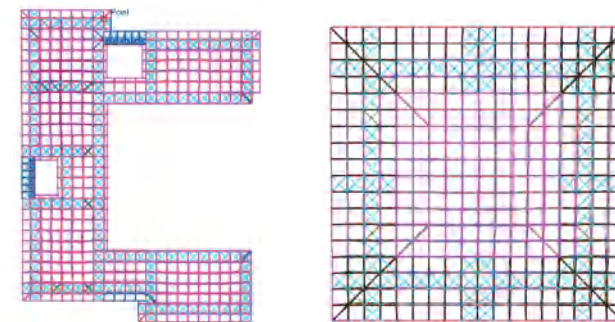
屋面桁架（一）计算简图 图4 屋面桁架（二）计算简图
